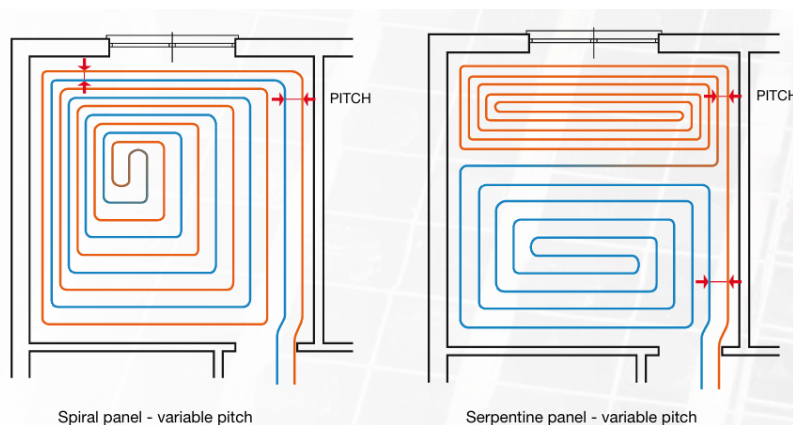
Instalação da tubagem do pavimento radiante em espiral e serpentina, com passo variável.
